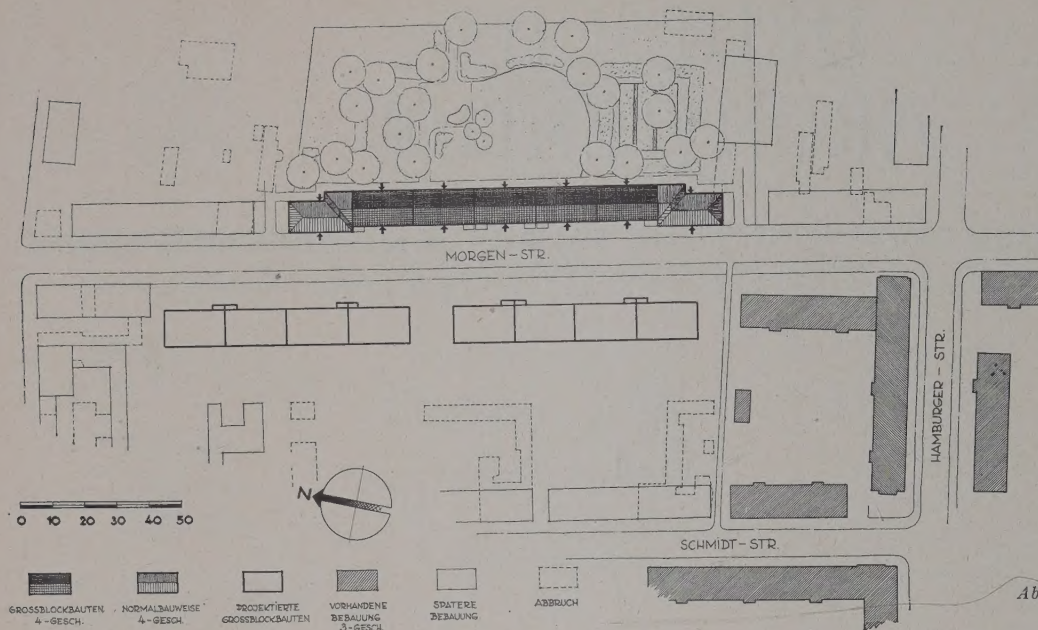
Lageplan Morgenstraße in Magdeburg-Neustadt
